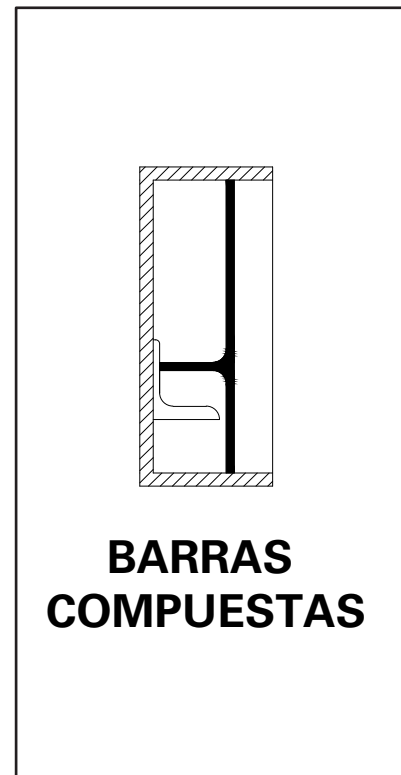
Barra compuesta utilizada como reposabrazos y barra de apoyo.
